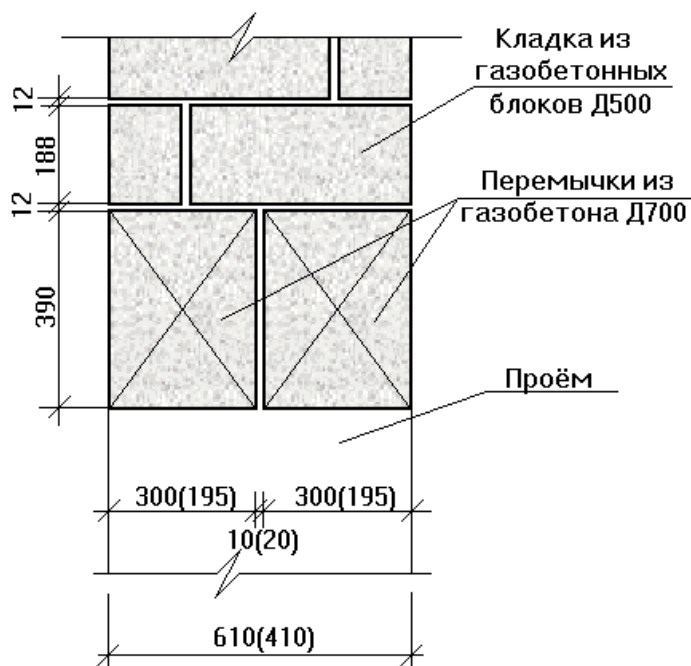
Пример выполнения проёма в наружных стенах толщиной 610мм и 410мм с использованием перемычек из газобетона.
